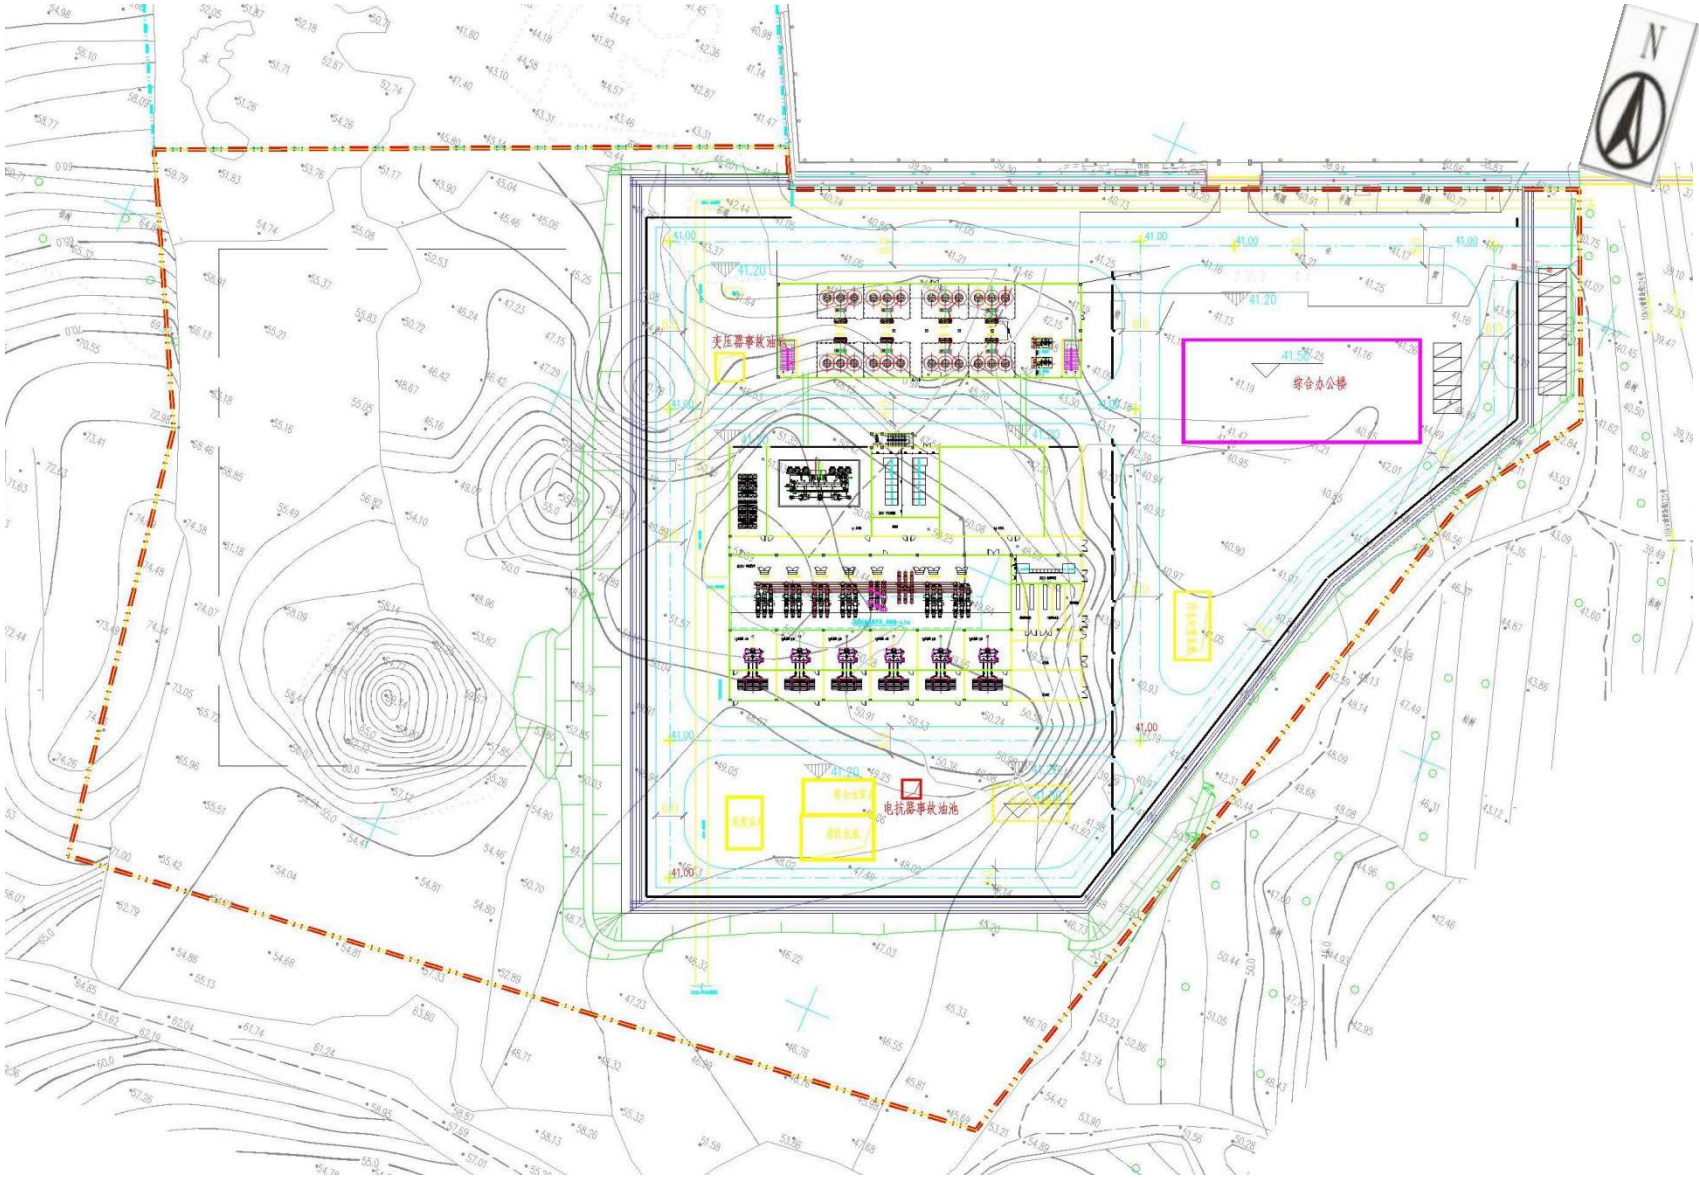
(a) 陆上集控运维中心总平面布置示意图
